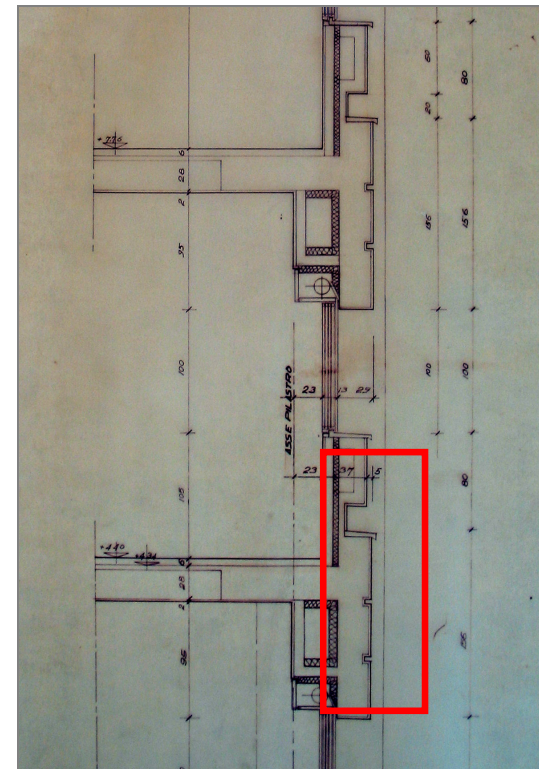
sezione corpo A – piano secondo (fonte CSAC – stralcio tav. 37, archivio n. 400-1, rielaborazione f.m.)
